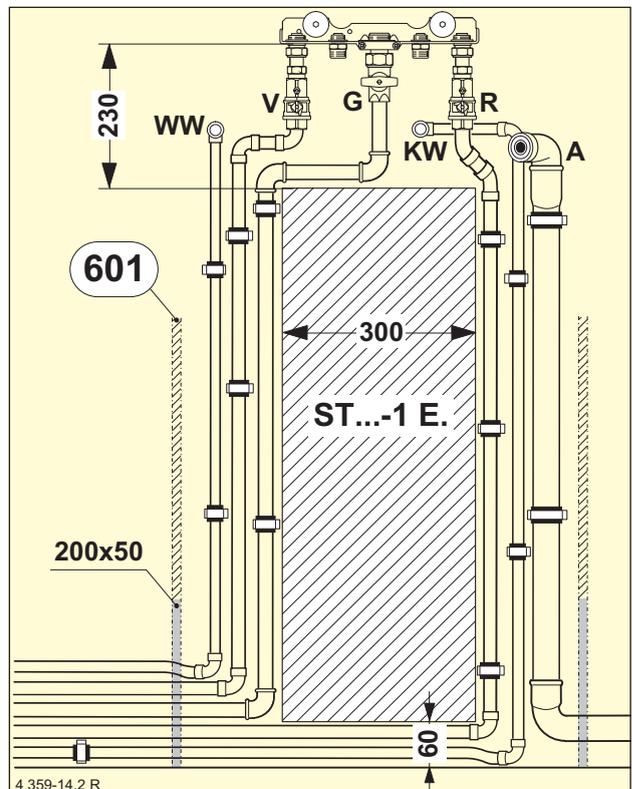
Bauseitige Aufputzverrohrung ohne Wandabstand
